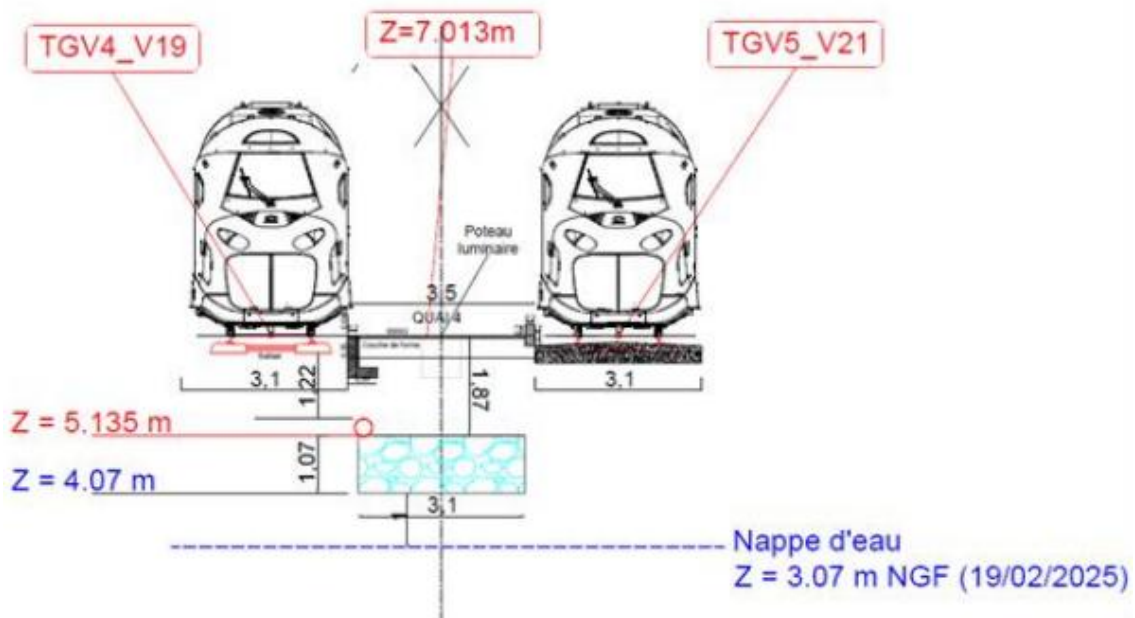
Coupe de la tranchée drainante sous le quai 4
